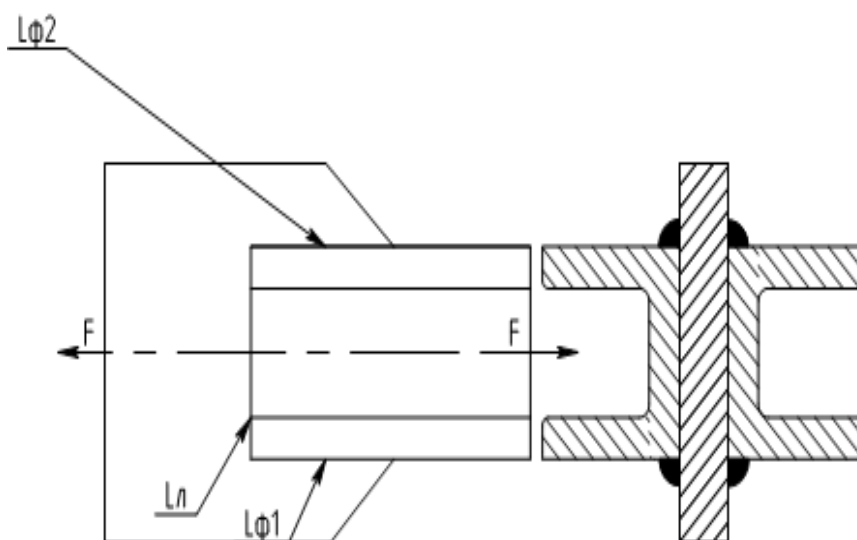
Стержень из двух швеллеров, приваренный к косынке
